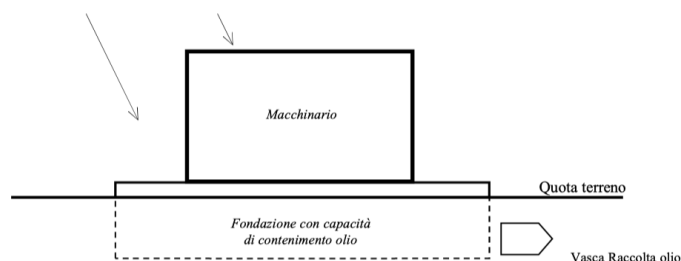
Rappresentazione schematica del sistema Vasca Fondazione
